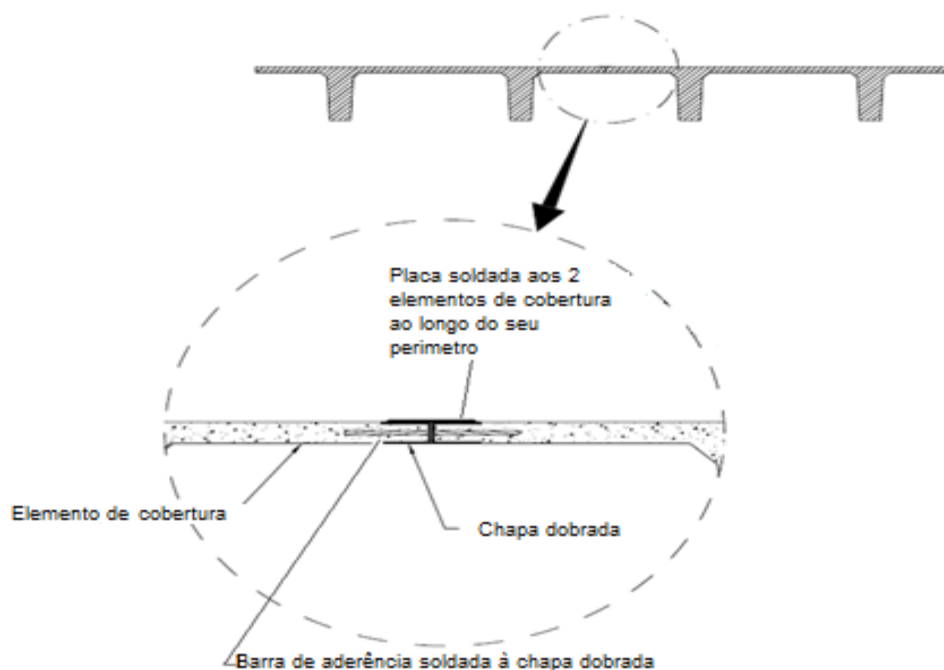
Intervenção para a ligação entre elementos de cobertura/pavimento – Ordem 1 –Tipo 3 [16]
